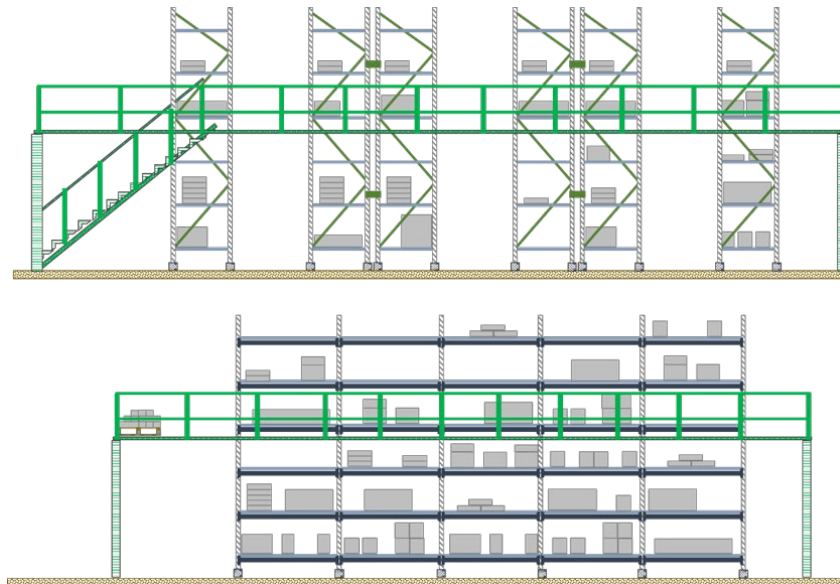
SISTEMA DE ESTANTERÍAS PARA PICKING
